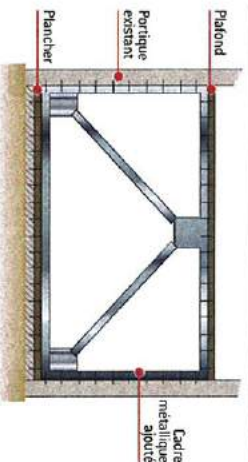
Exemple de renforcement du contreventement par ajout de croix type X ou Saint-André en charpente métallique ou en poutre de béton armé d'un portique existant. (coupe transversale)
